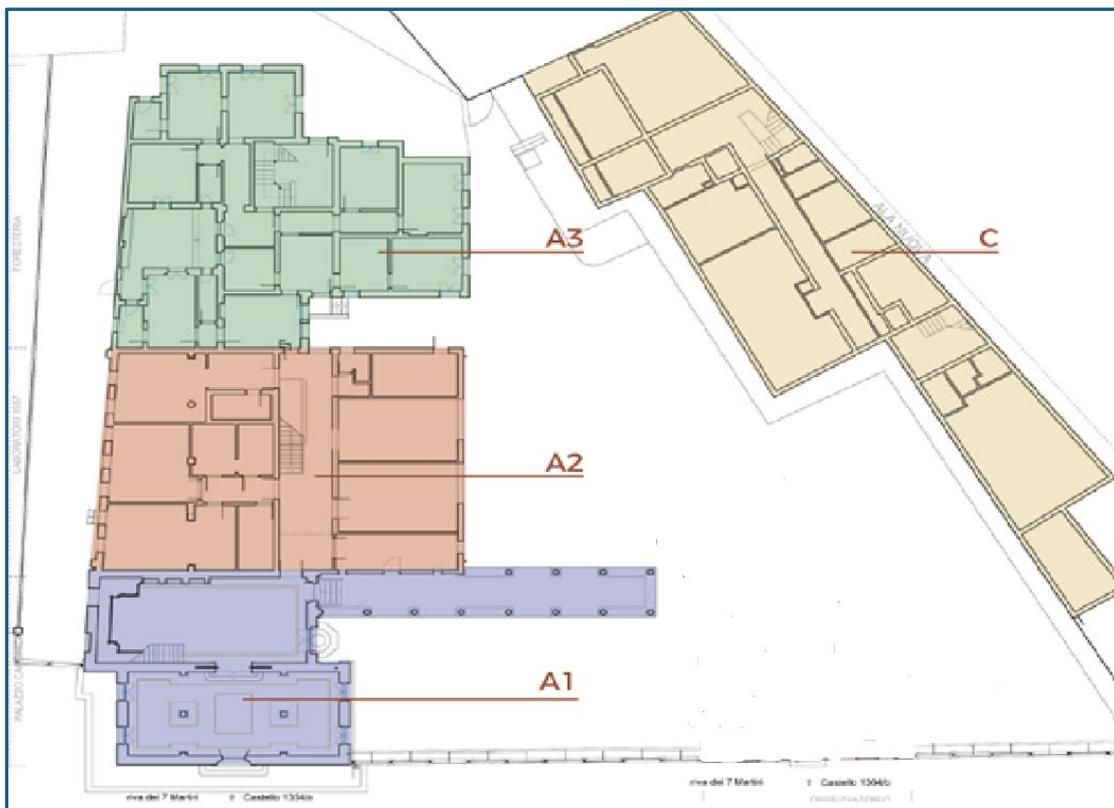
Individuazione dei quattro edifici, oggetto di interventi di valorizzazione e restauro
